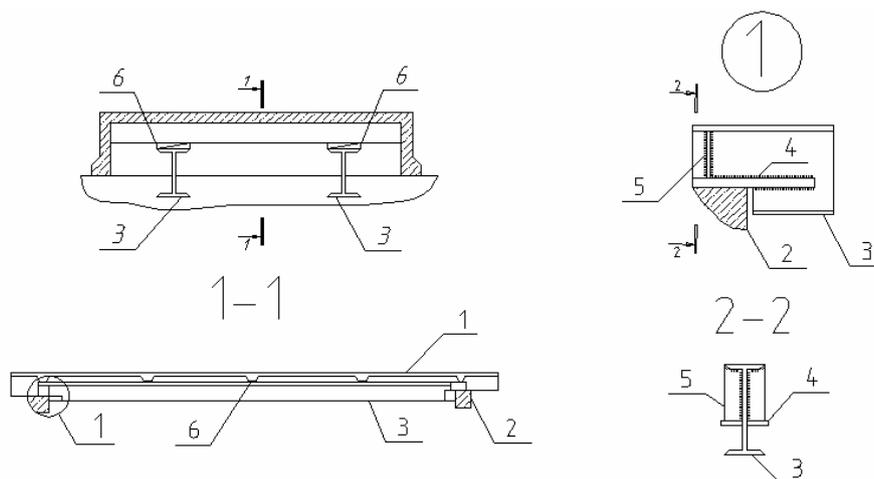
Усиление ребристых плит установкой балок из двутавров с подрезками у опор: 1 – усиливаемые плиты; 2 – балка (ферма); 3 – разгружающие балки из двутавра с подрезками на опорах; 4 – опорная пластина; 5 – ребра жесткости; 6 – металлические пластины-клинья для включения разгружающих балок в работу
